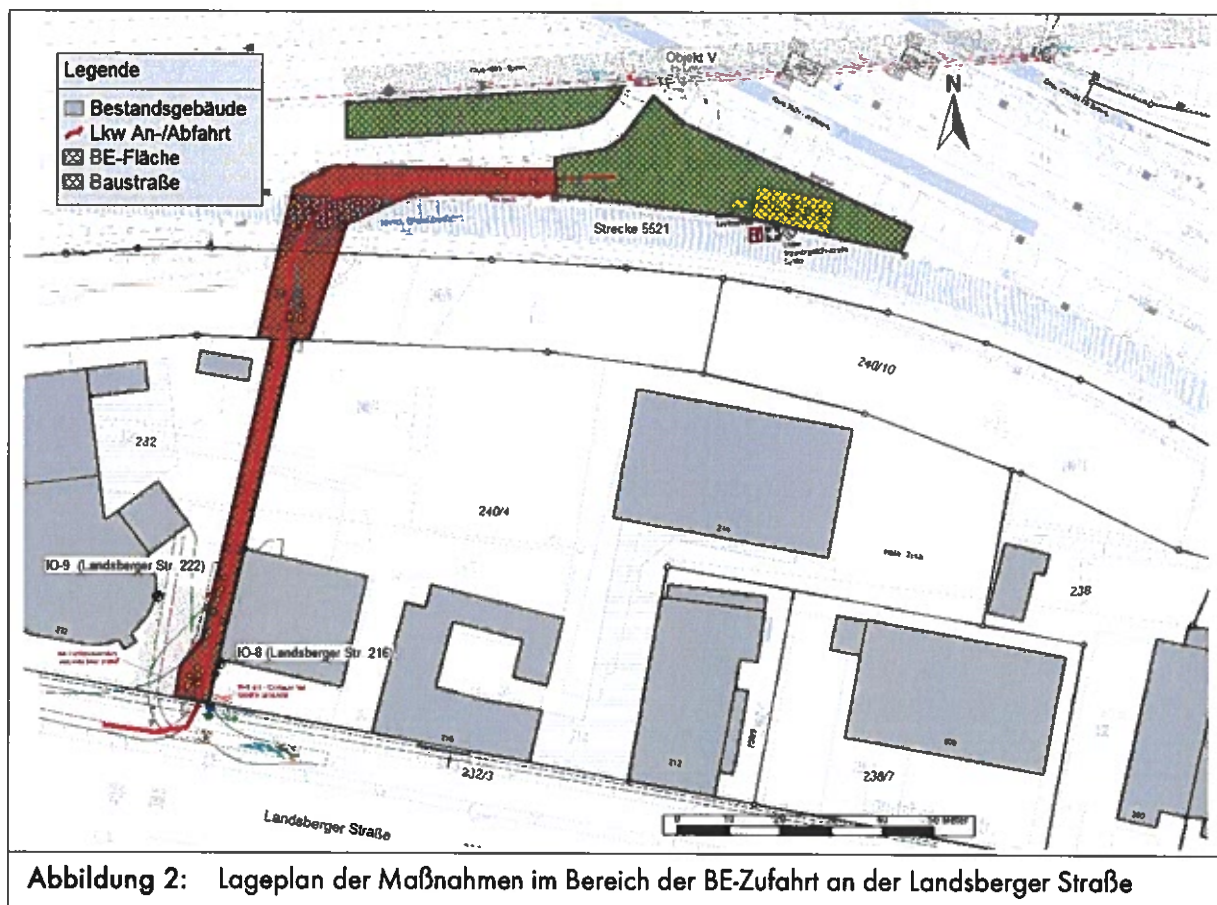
Lageplan der Maßnahmen im Bereich der BE-Zufahrt an der Landsberger Straße
